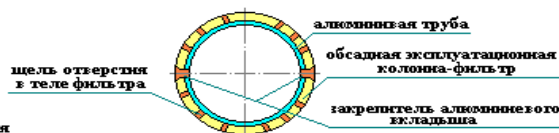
Установка алюминиевого вкладыша внутри фильтра
